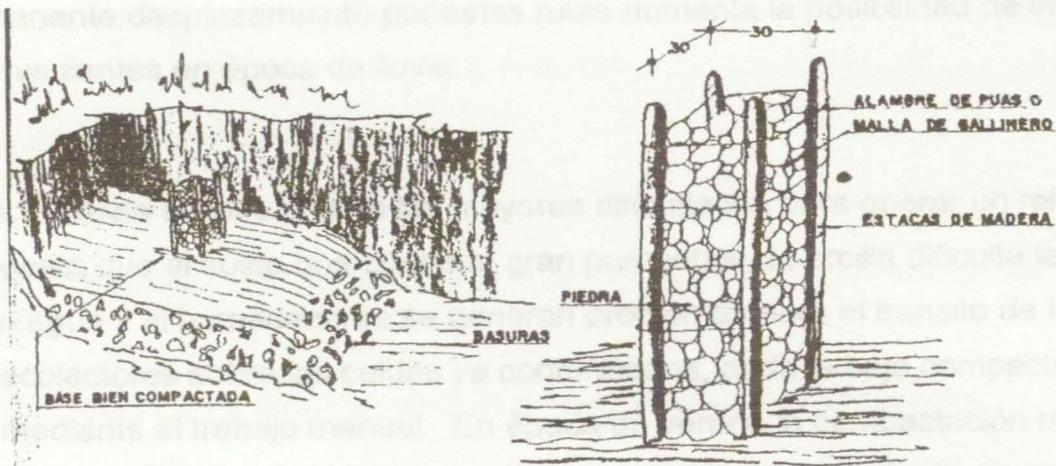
Detalle Constructivo del Filtro para drenaje de Gases c/20m.
